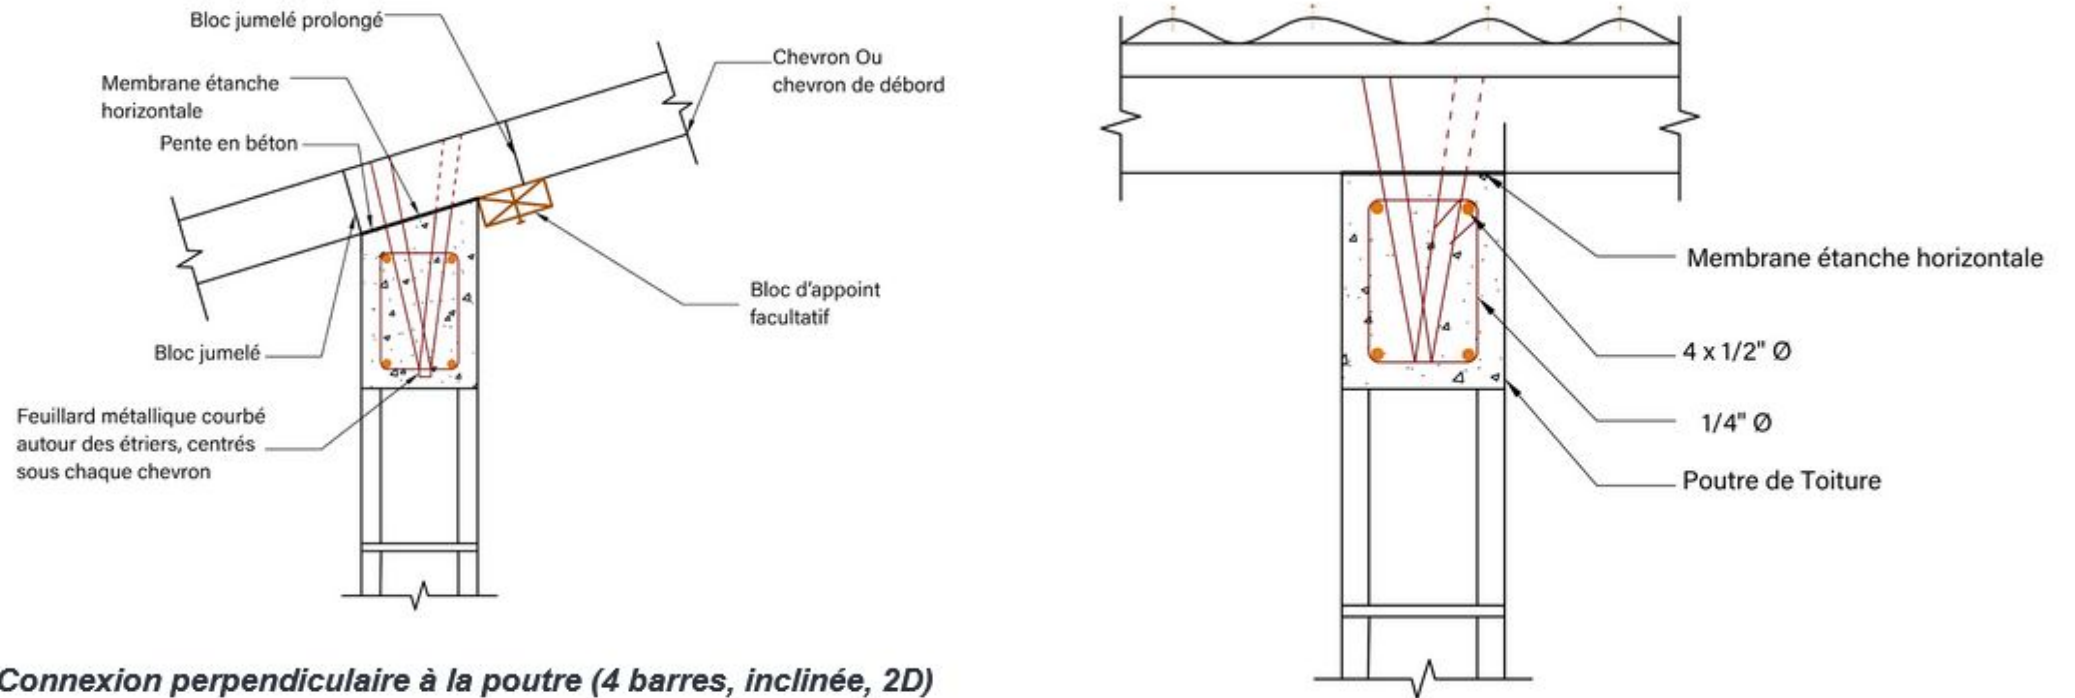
Connexion perpendiculaire à la poutre (4 barres, inclinée, 2D)
